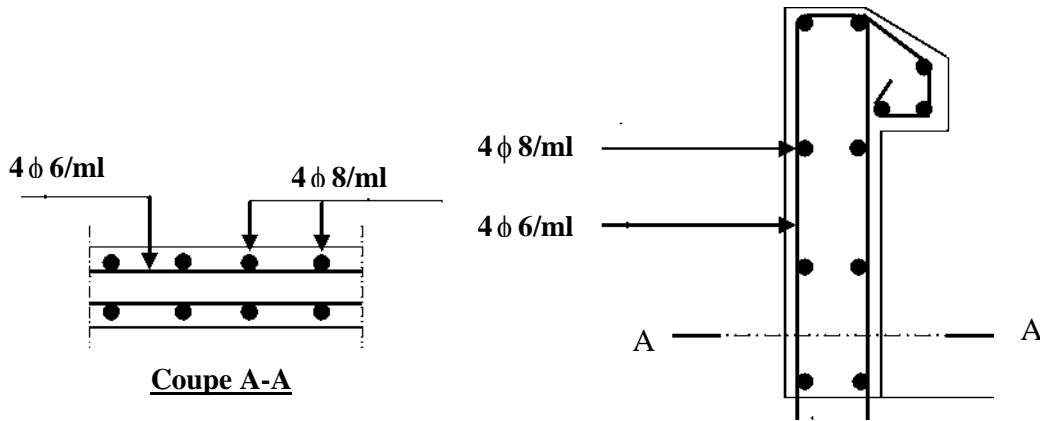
Schéma de ferrailage de l'acrotère (Terrasse inaccessible).
